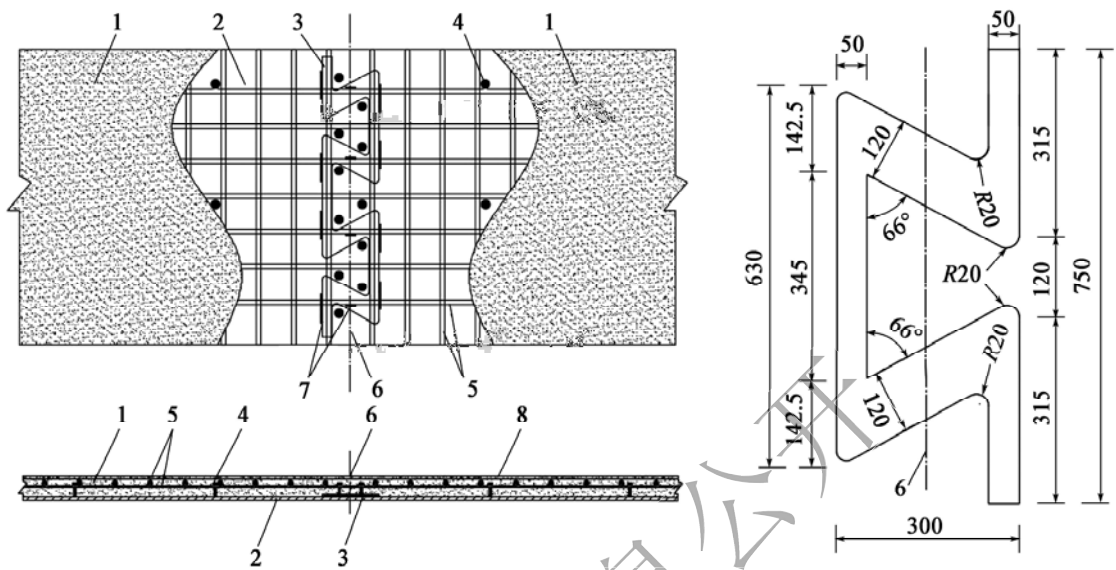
Z 形钢板施工缝构造示意 (尺寸单位: mm)
